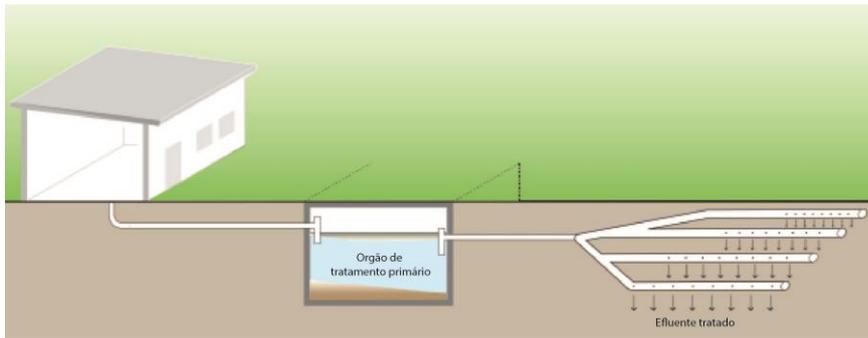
Esquemática da utilização de trincheiras de infiltração precedidas por um órgão de tratamento primário. Adaptado de Tilley, et al., 2008.
